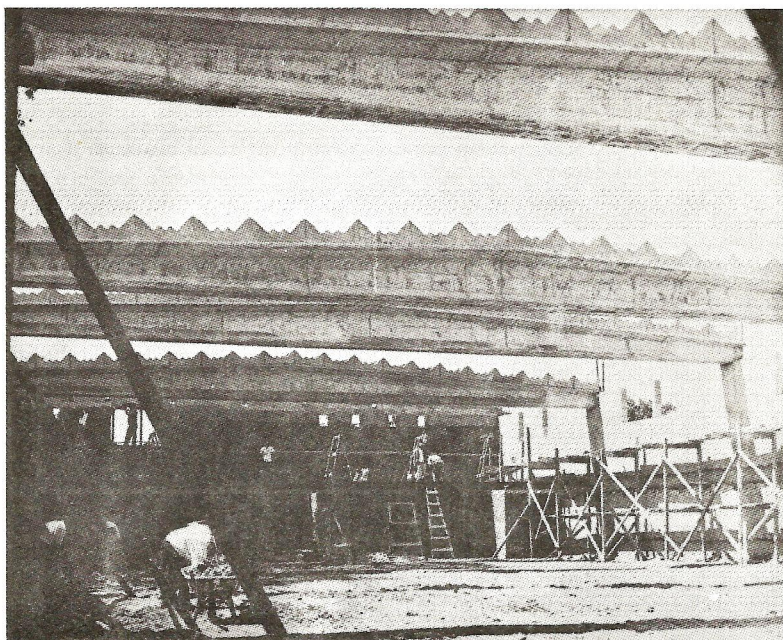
Vigas de carga pretensadas en 20.00 m.l. de Luz.
